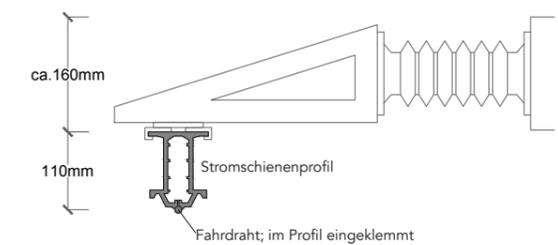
Deckenstromschiene DSS CR4; Furrer+Frey Detail 1:10
